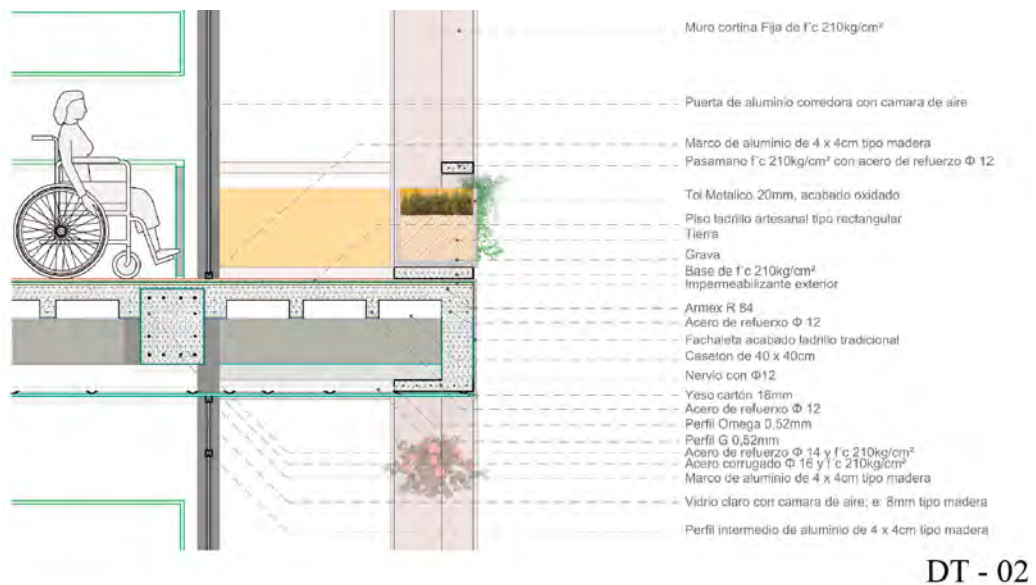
DT – 02 Sección constructiva – entrepiso
